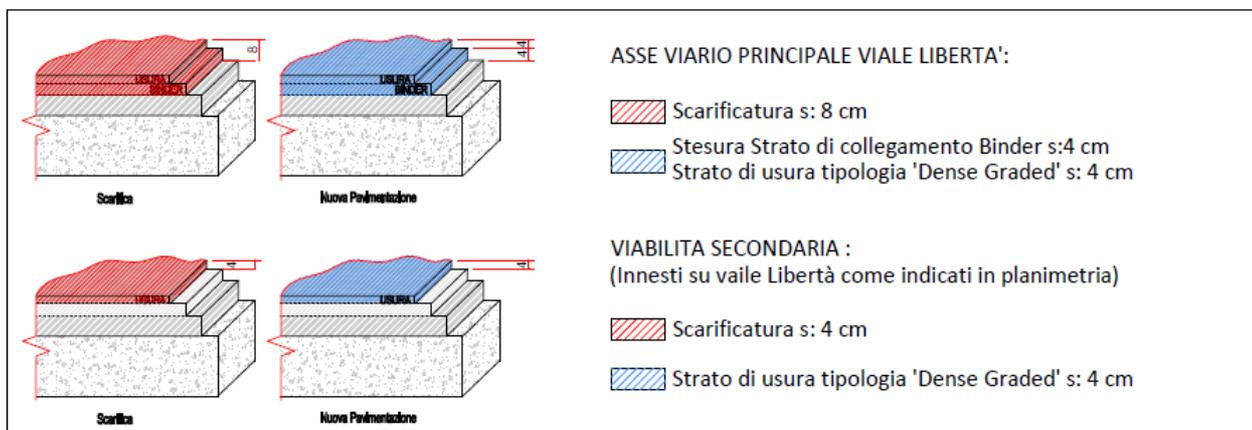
particolare nuova pavimentazione stradale fonosorbente
